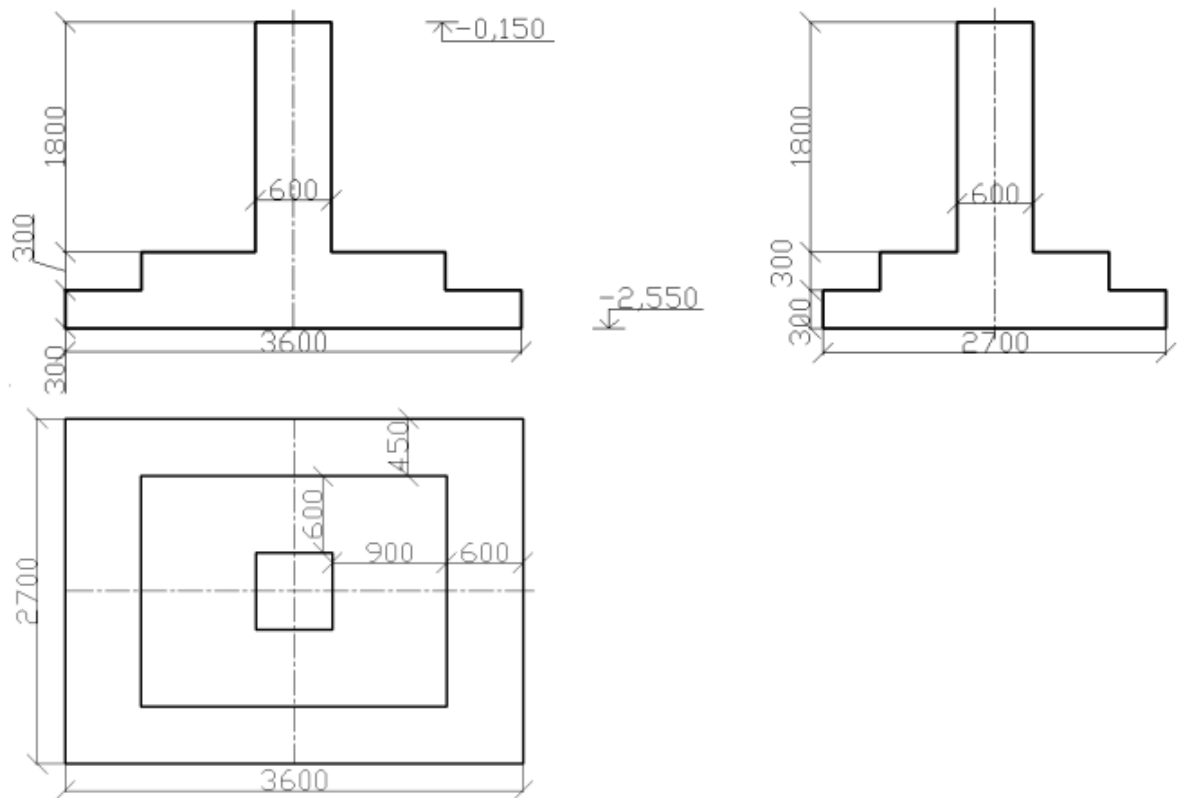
Стівчастий фундамент під крайню рядову колону
